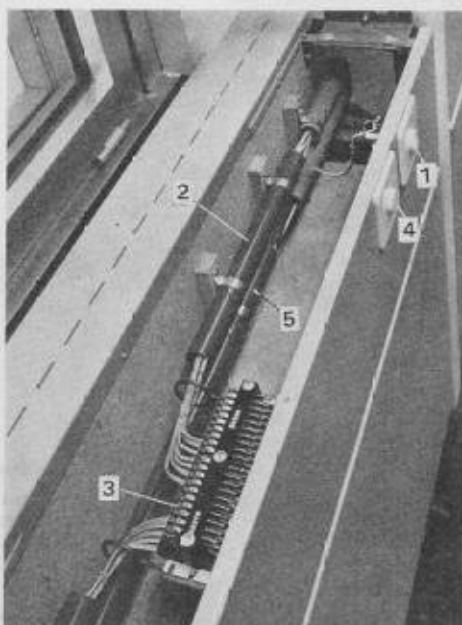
In die Kernwand eingebauter Schützerkasten für Bürobeleuchtung
